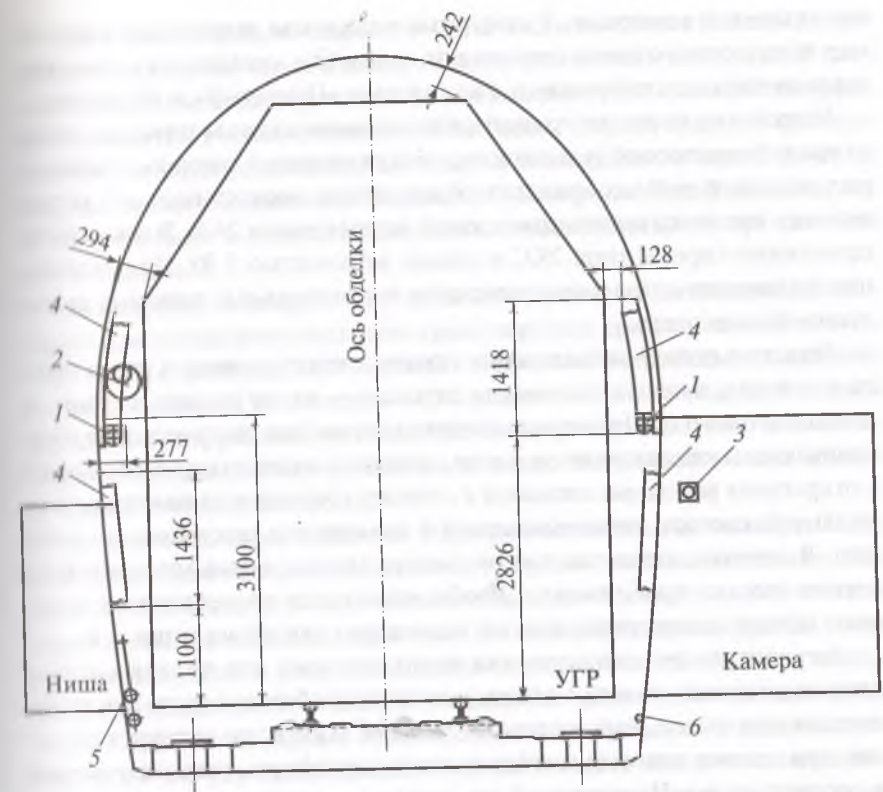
Схема размещения сигнальных устройств в сечении тоннеля: 1 — светильник НСР01х200; 2 — сирены (гудки) ГПР; 3 — кнопки КУ 123-1; 4 — кабельные кронштейны; 5 — противопожарный трубопровод; 6 — трубопровод сжатого воздуха
